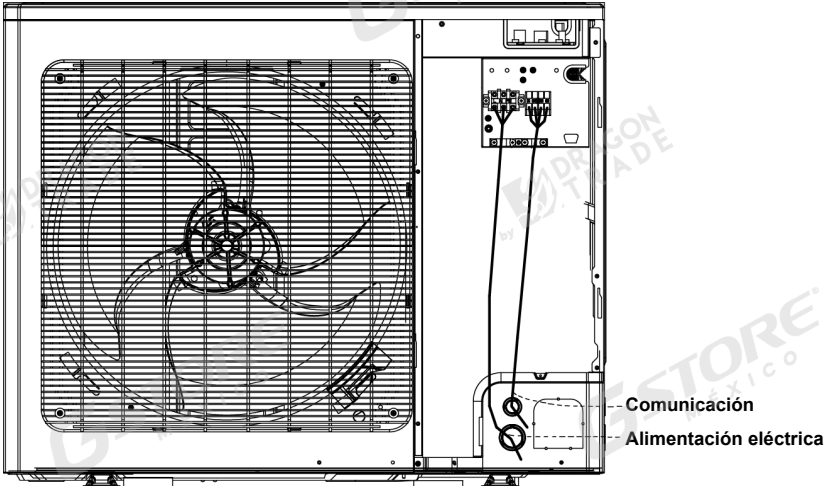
Vista del cableado de ingeniería de GMVL-80WL/C-T(D), GMVL-100WL/C-T(D), GMVL-120WL/C-T(D)
